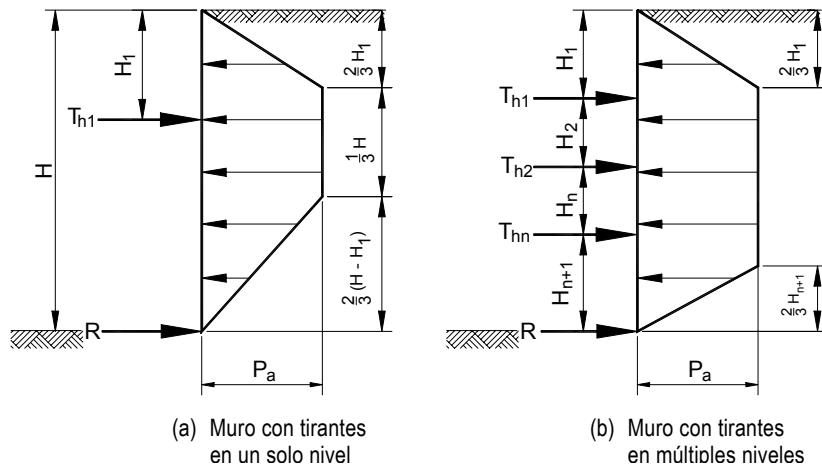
Distribuciones del empuje aparente para muros anclados construidos de arriba hacia abajo en suelos no cohesivos
